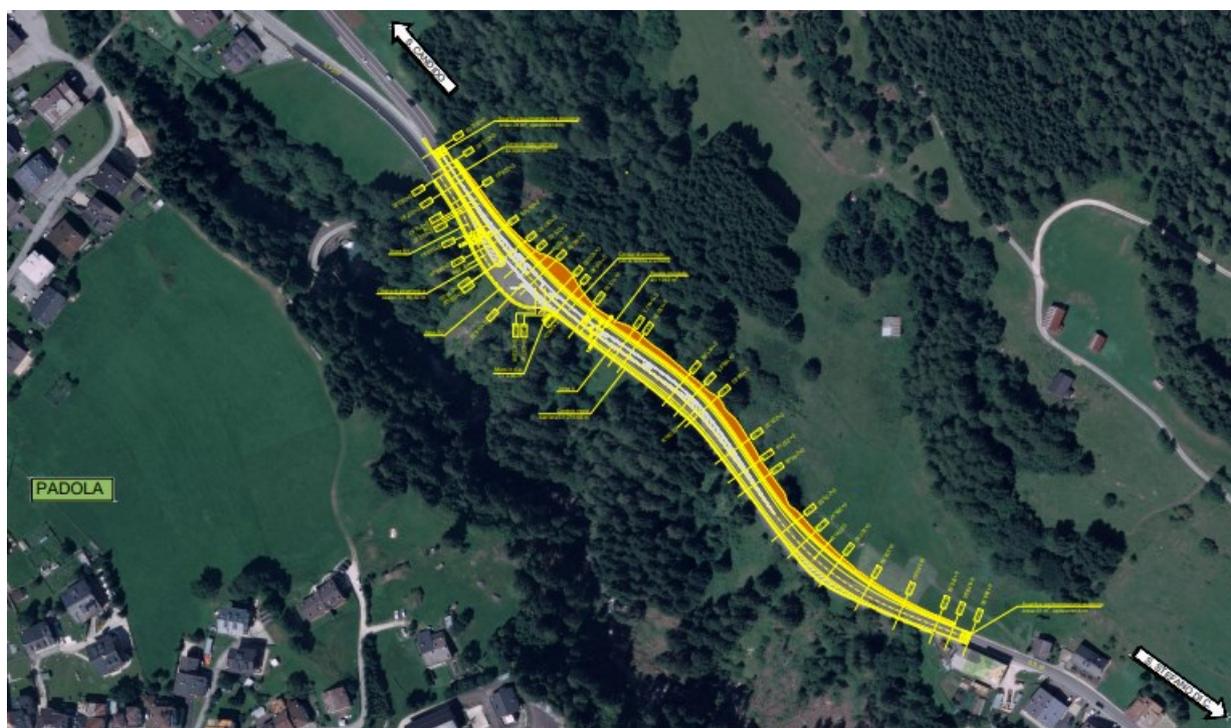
Planimetria di progetto su ortofoto Fonte: Planimetria di progetto e montaggio su ortofoto
